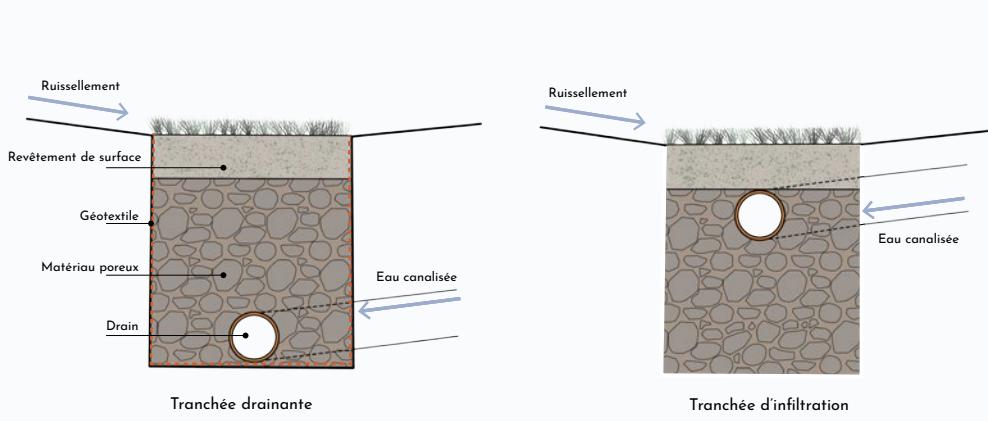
Schéma en coupe d'une tranchée drainante et d'une tranchée infiltrante.
